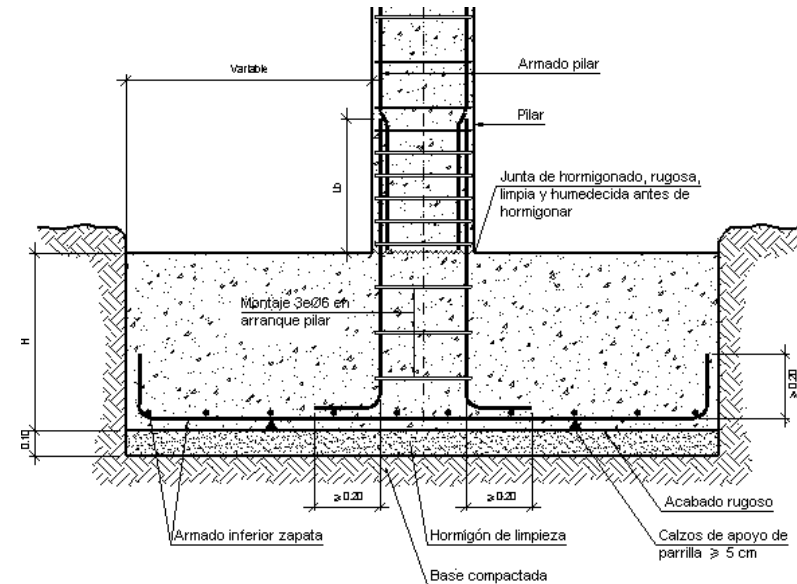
Detalle Constructivo de lo Que Serán Las Zapatas Aisladas Que soportarán el Edificio.
